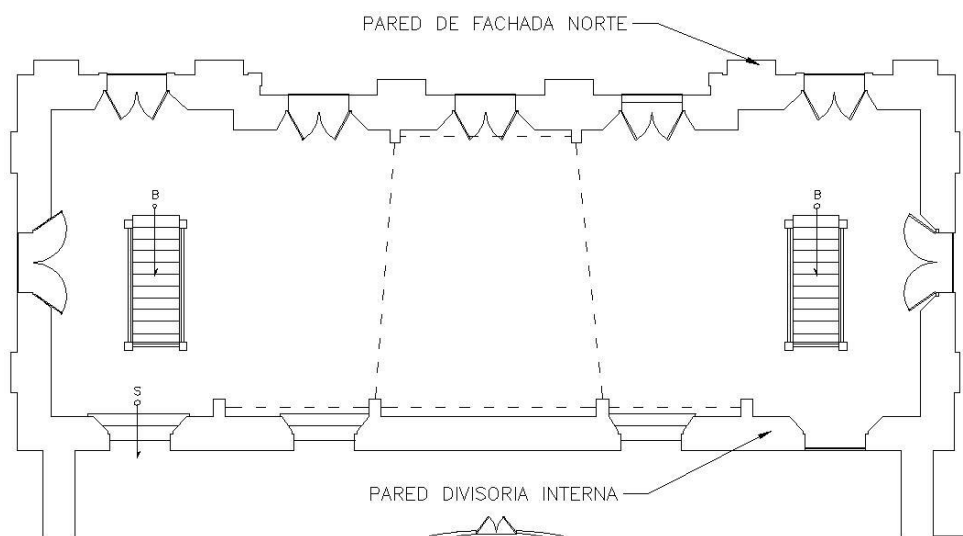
Vista en planta del Salón Foyer. Se observa que los ejes entre las columnas (líneas discontinuas) no son colineales entre sí.
